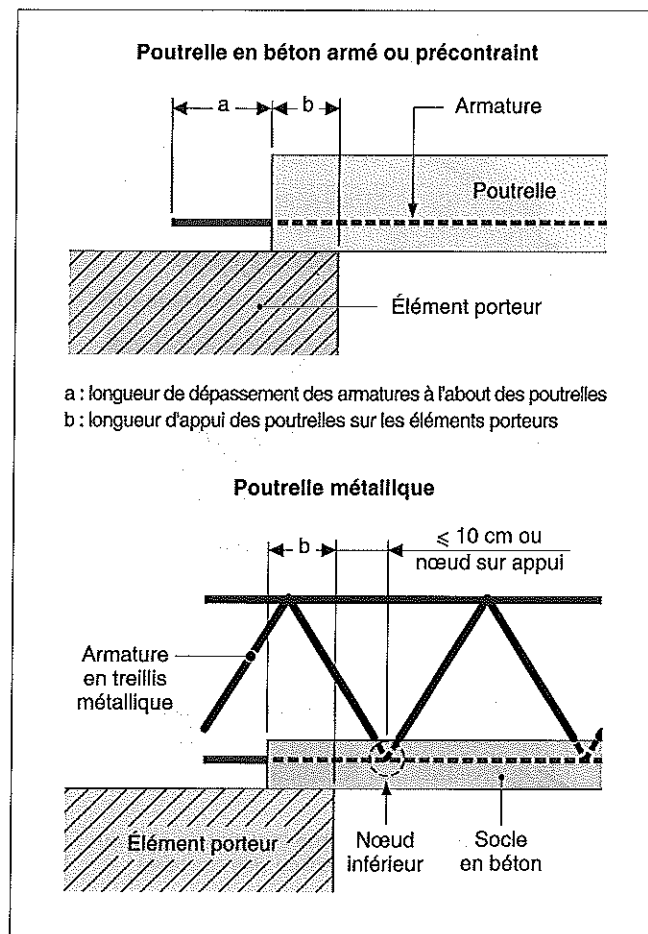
Conditions d'appuis des poutrelles préfabriquées.
